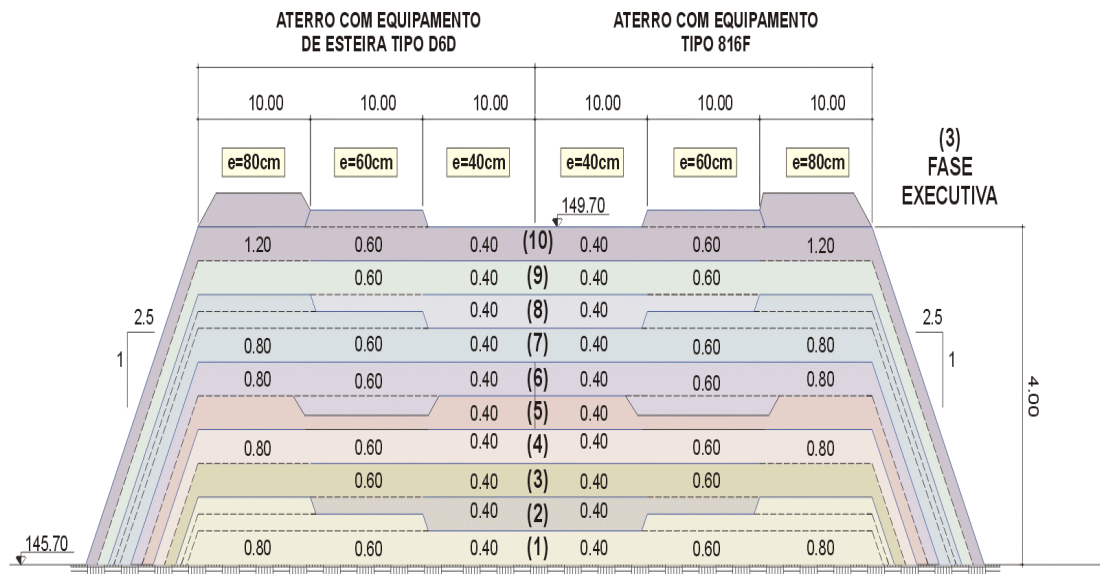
Aterro experimental – Seqüência construtiva da praça de trabalho em planos horizontais
